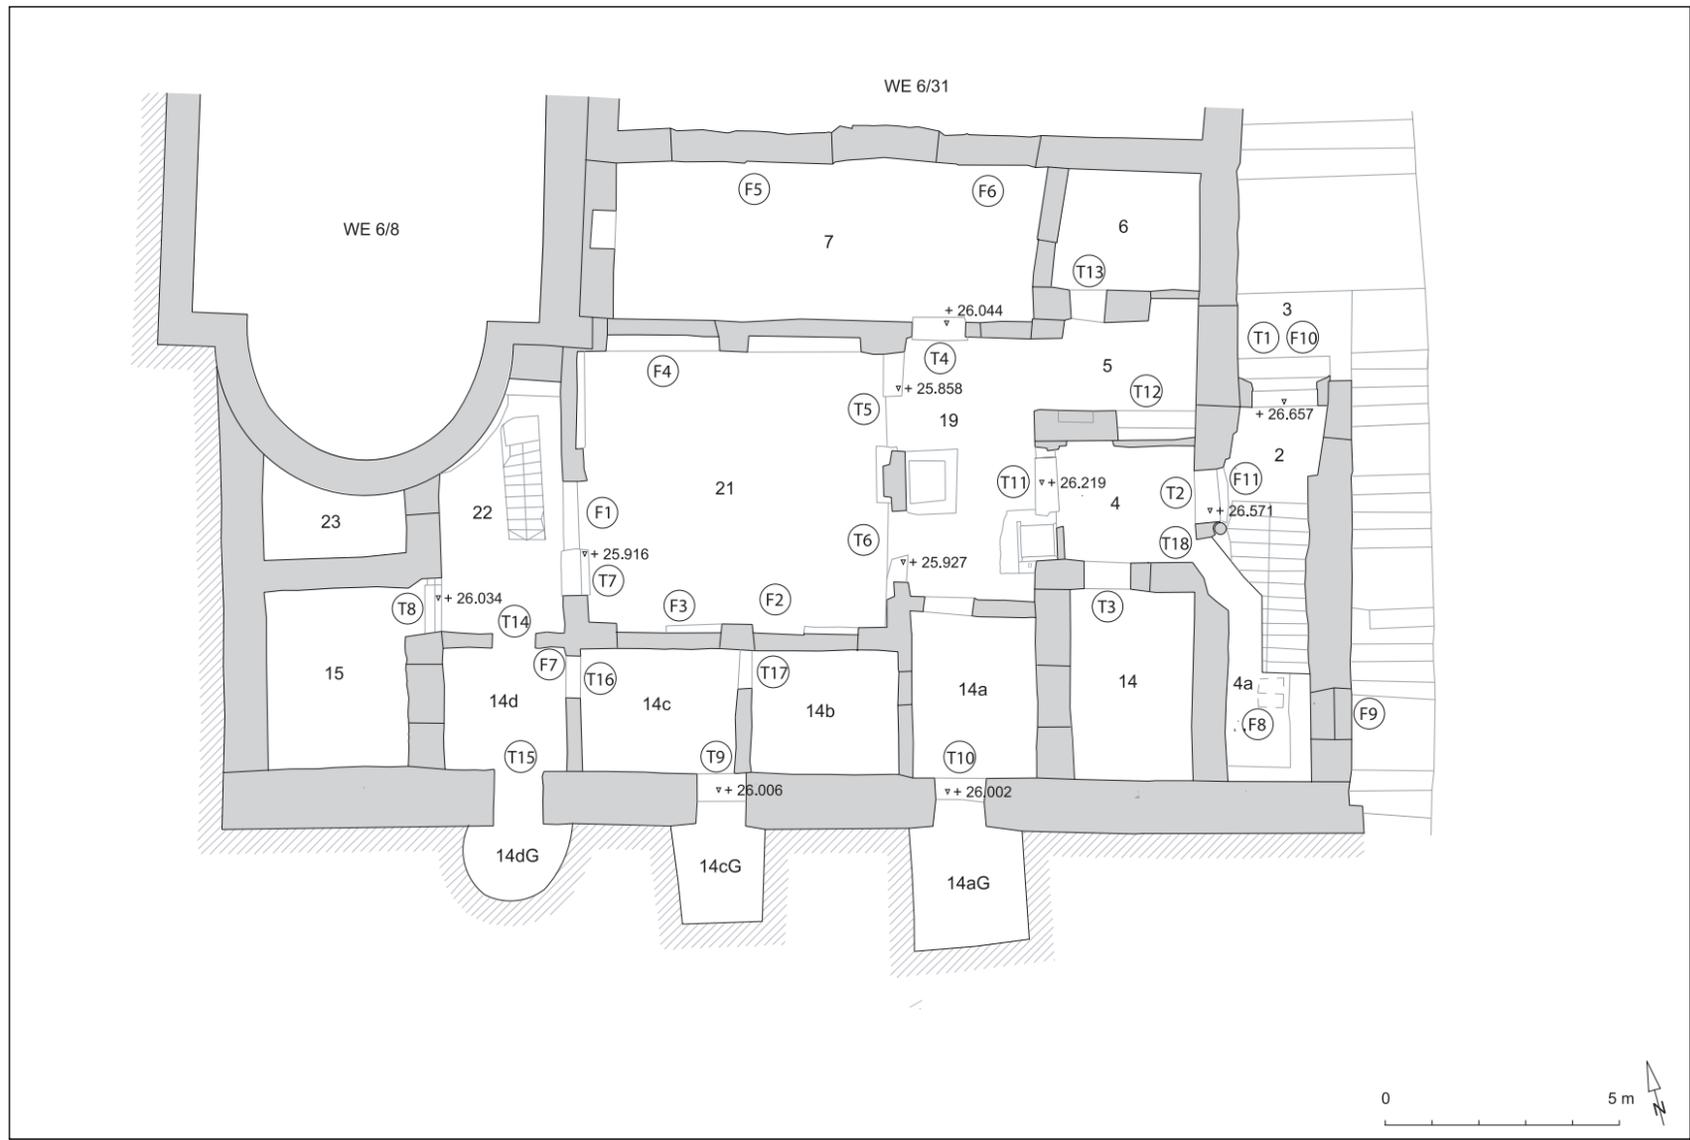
Plan mit Türen und Fenstern (M 1:150)
